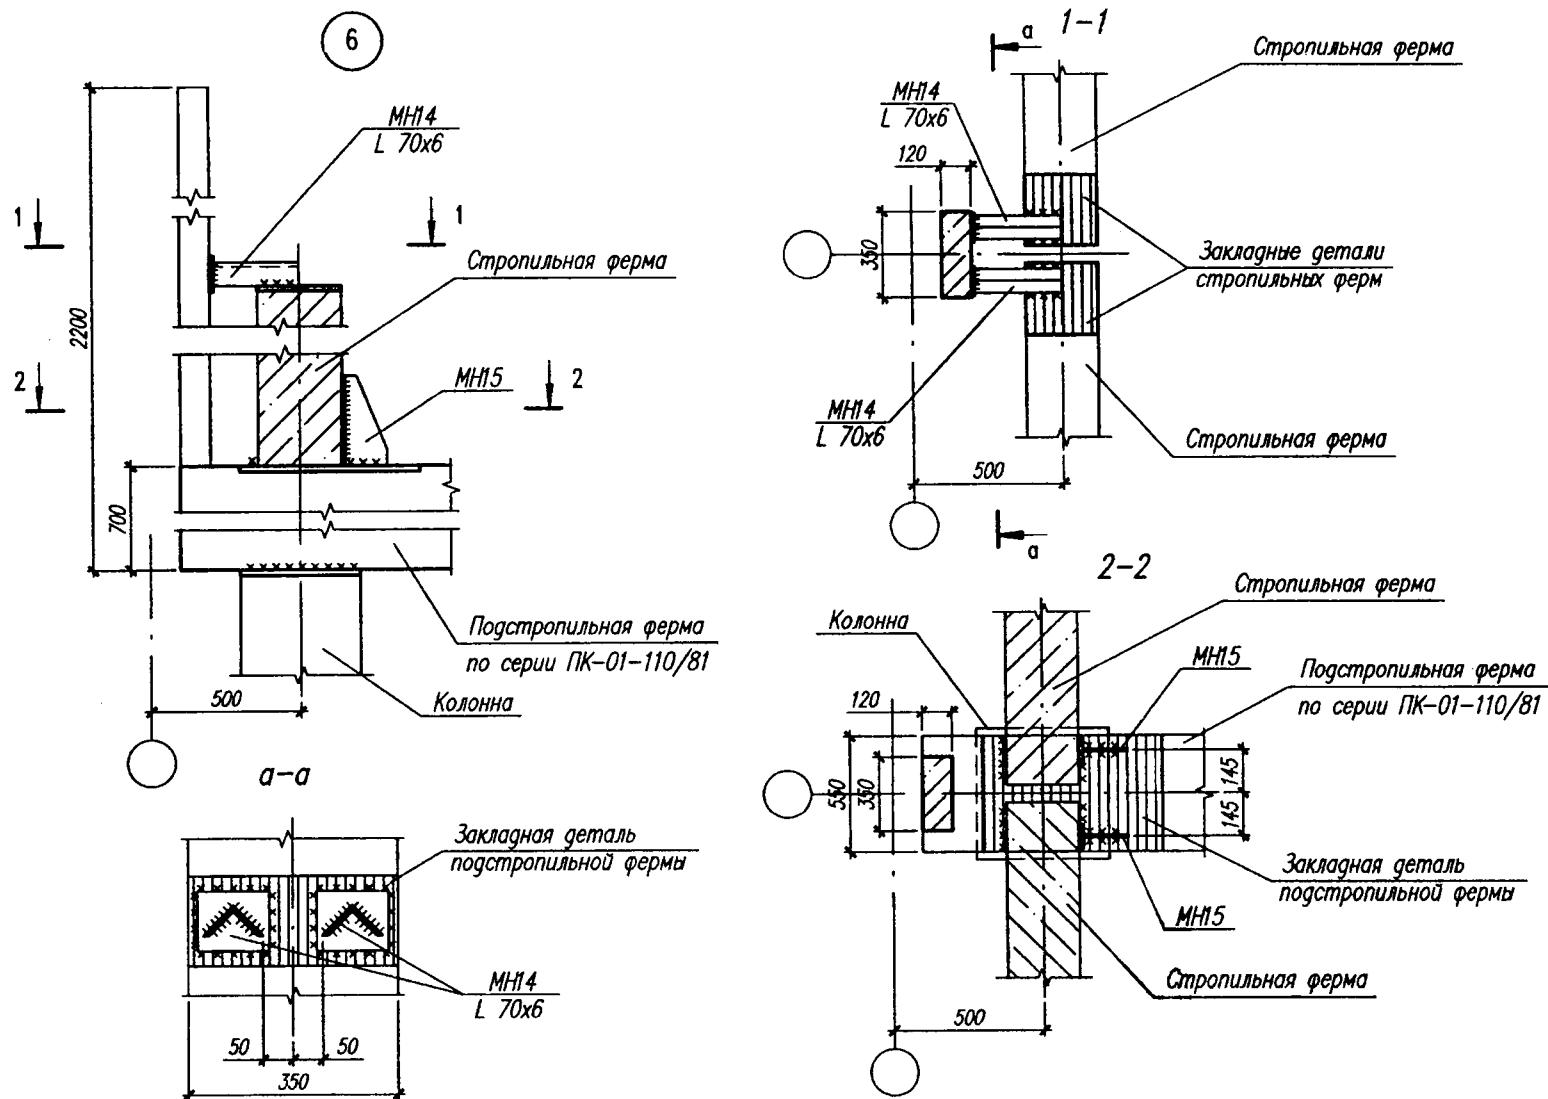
Узел опирания стропильной фермы для скатной кровли на подстропильную ферму в торце здания
